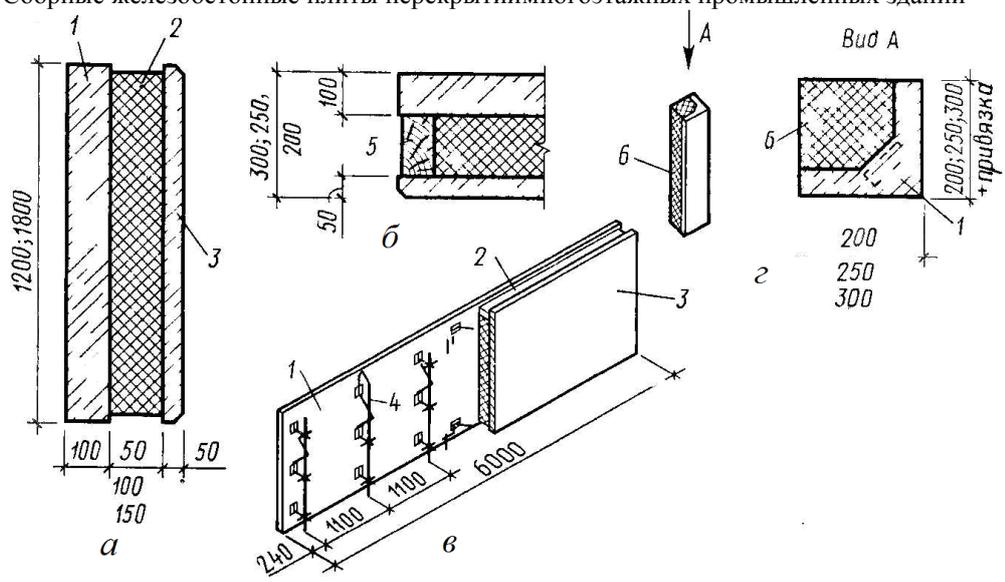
Трехслойные сборные железобетонные стеновые панели промышленных зданий:
